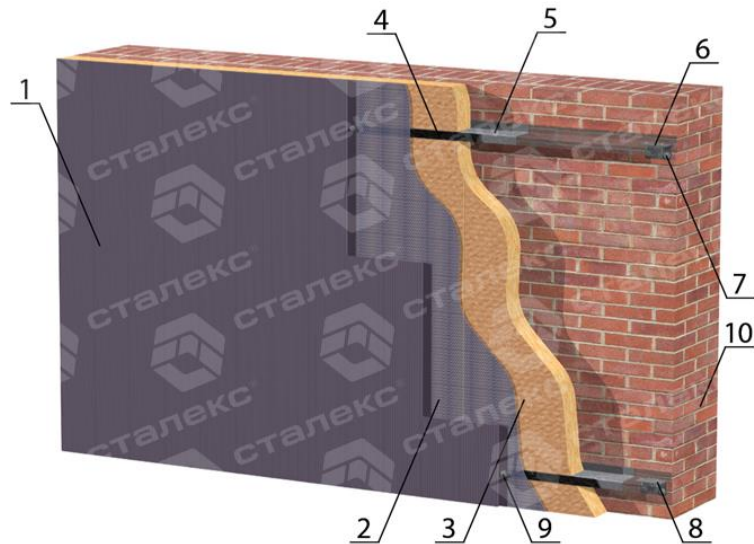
Приклад конструкції навісного вентиляваного фасаду
